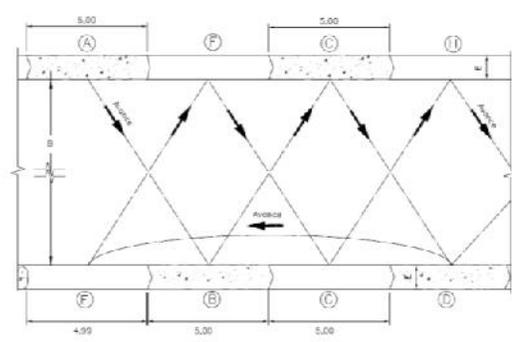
Secuencia de construcción de las pantallas preexcavadas (planta)
